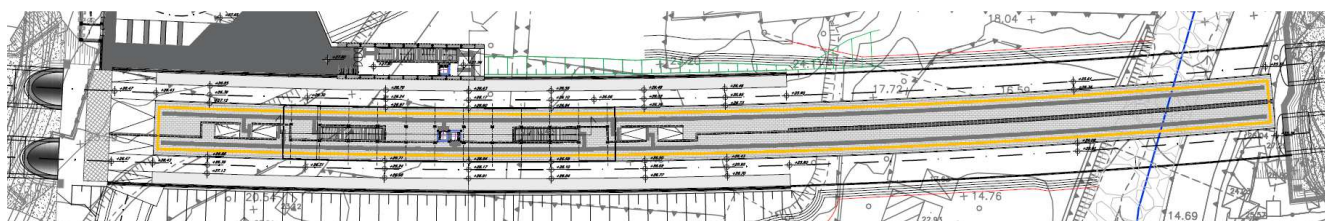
Pianta quota banchina Fermata Itala-Scaletta (Rif. [29])
